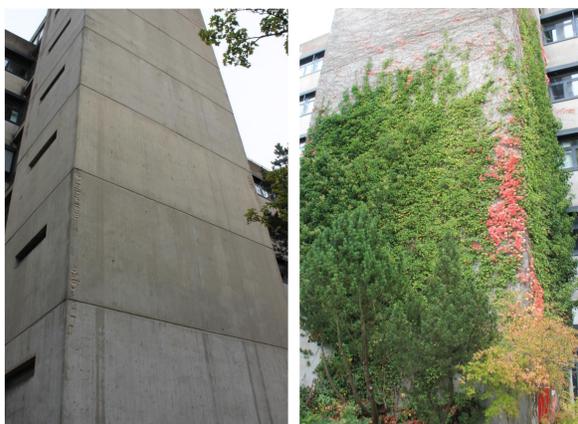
Unbegrünte Fassade am Maschinenbauinstitutsgebäude, Abb. 2: Begrünte Fassade am Maschinenbauinstitutsgebäude, eigene Aufnahme
